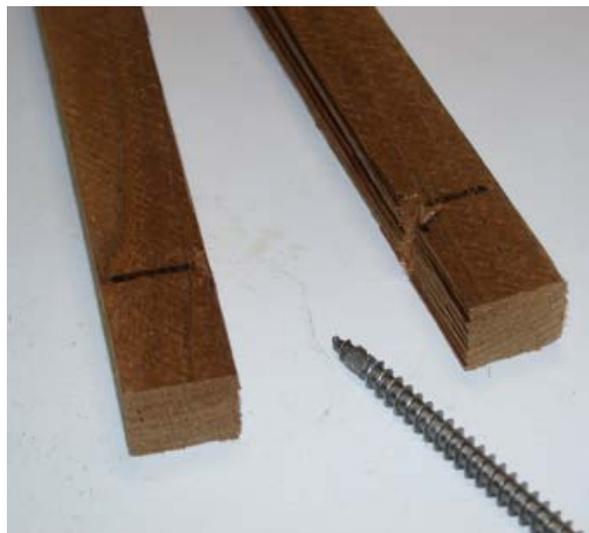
& 139 - Bruchbilder bei der Anwendung einer SPAX-S Schraube (links) oder einer selbstschneidenden Edelstahlschraube (rechts)
